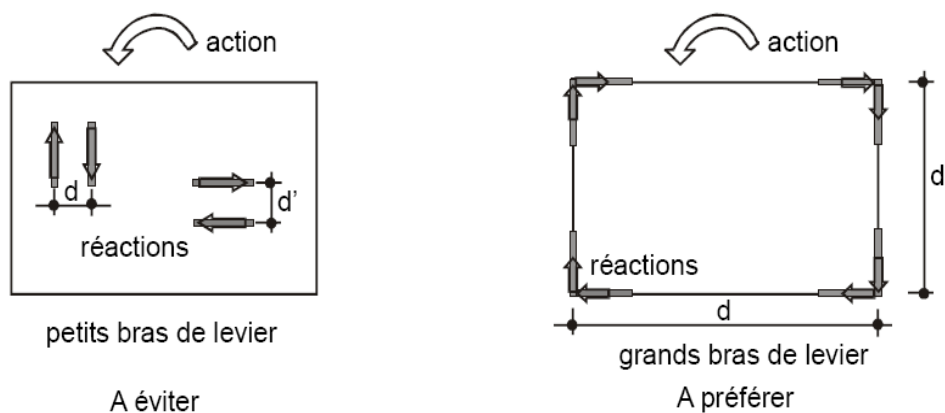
Risque de la torsion du à un bras de levier important dans le plan horizontal.
